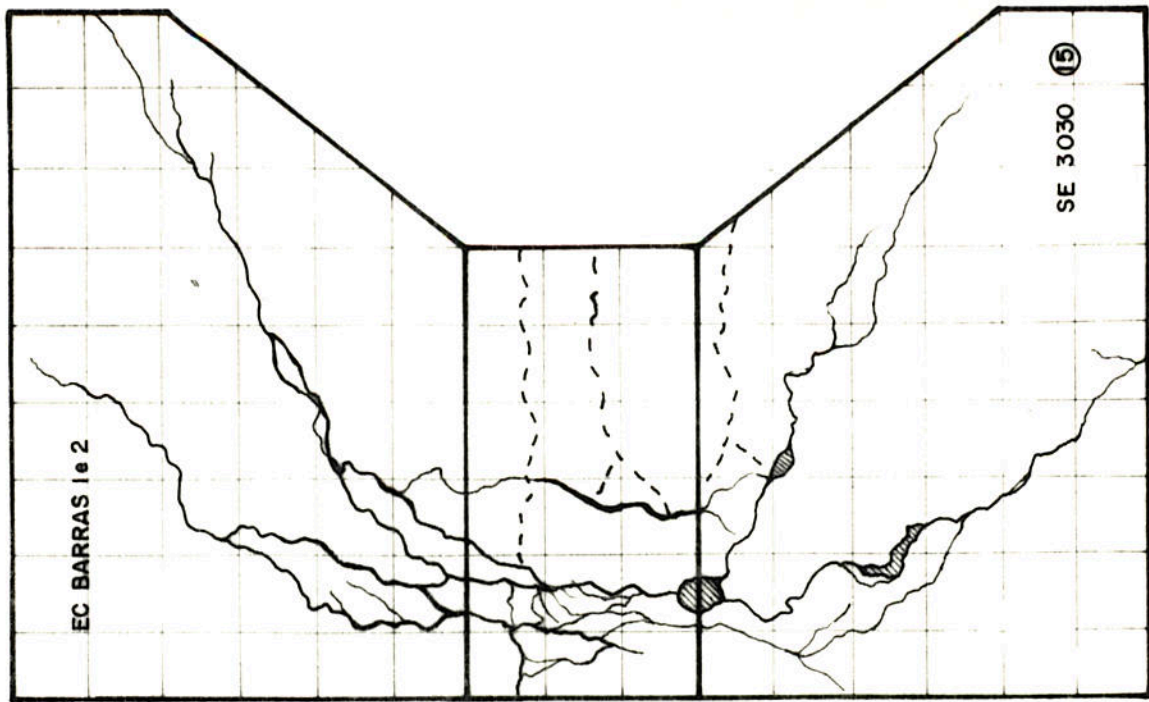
Fissuração dos CP SE 3030
